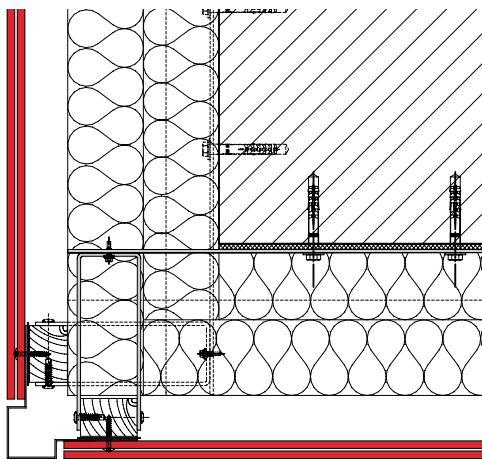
DETAILS STÜLPSCHALUNG MIT SCHRAUBE
